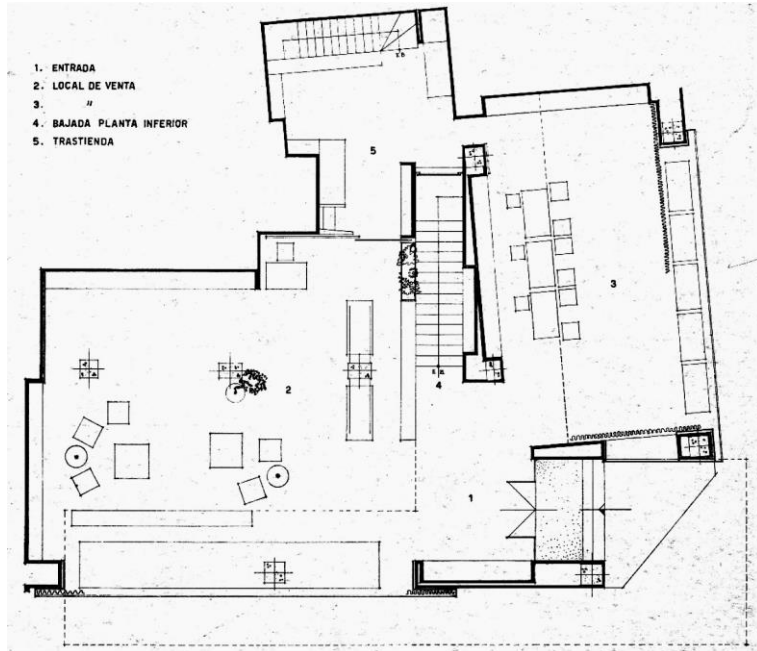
Planta de la Tienda de Loewe, calle Serrano esquina con calle Jorge Juan; arquitecto Javier Carvajal, enero 1960
